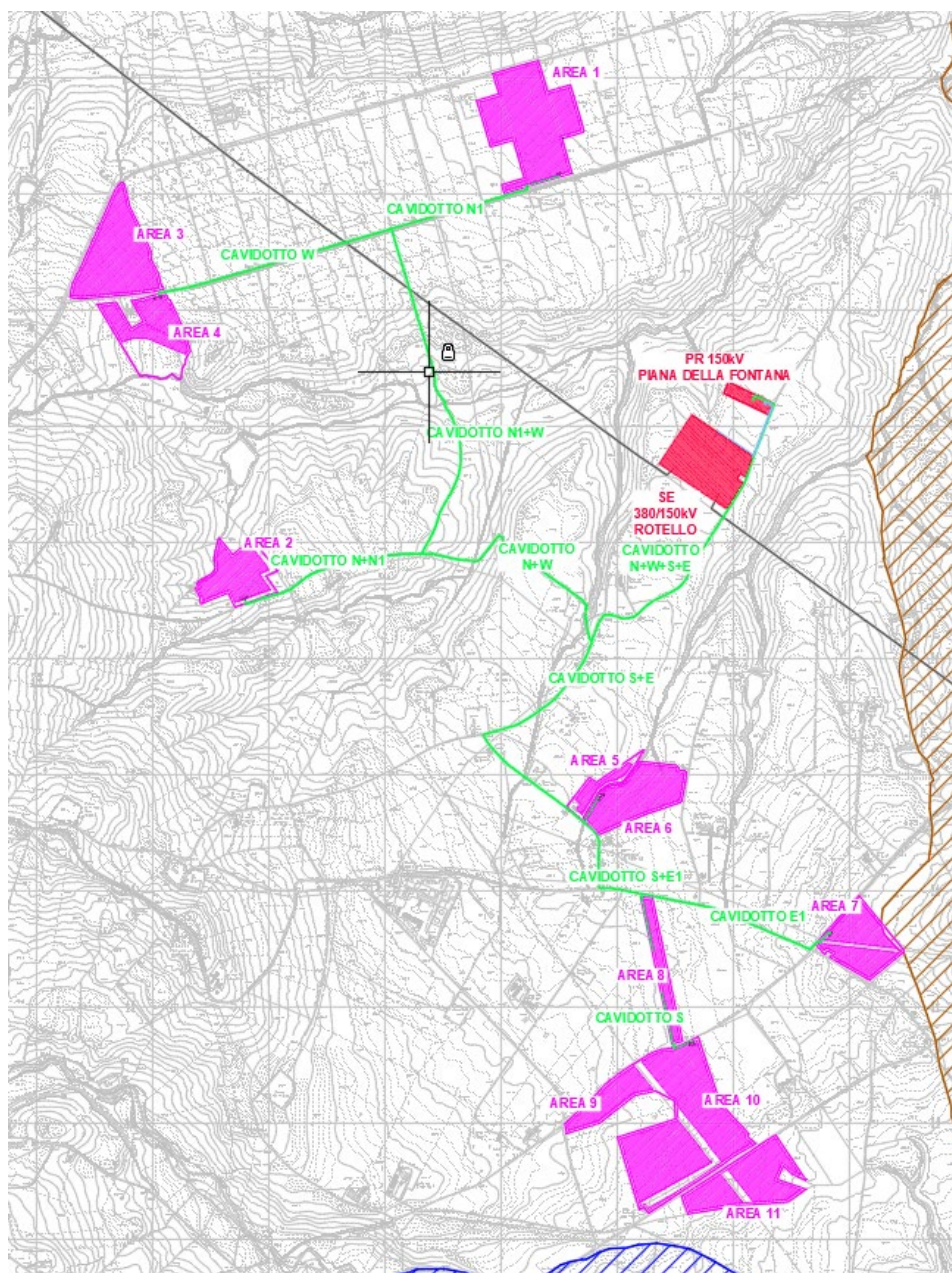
Planimetria CTR con indicazione dei percorsi dei cavidotti
